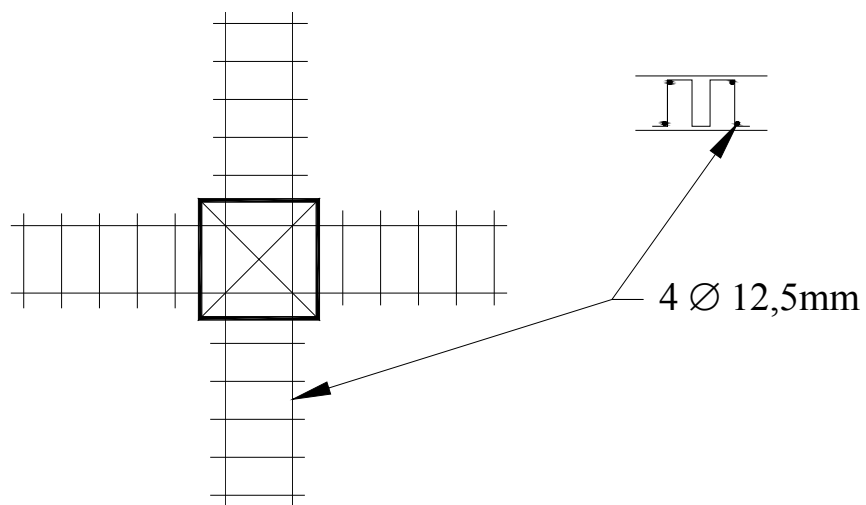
20 Armadura de punção com armadura de montagem em vigas cruzadas
